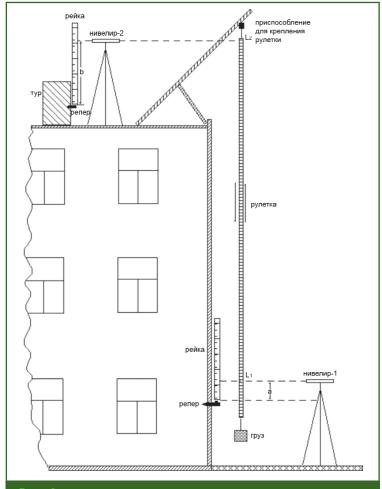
Схема передачи высот на пункт, расположенный на крыше здания
